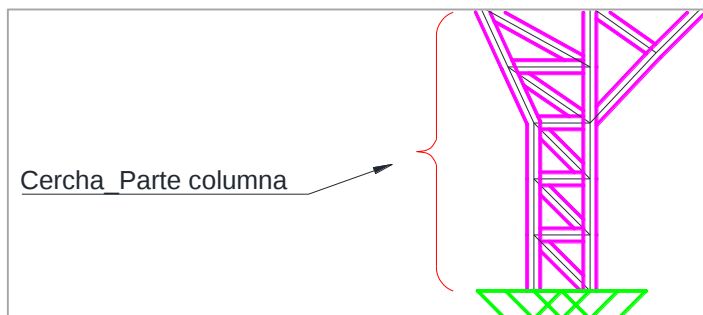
Parte Columna; foto Campo ferial B/El Constructor
